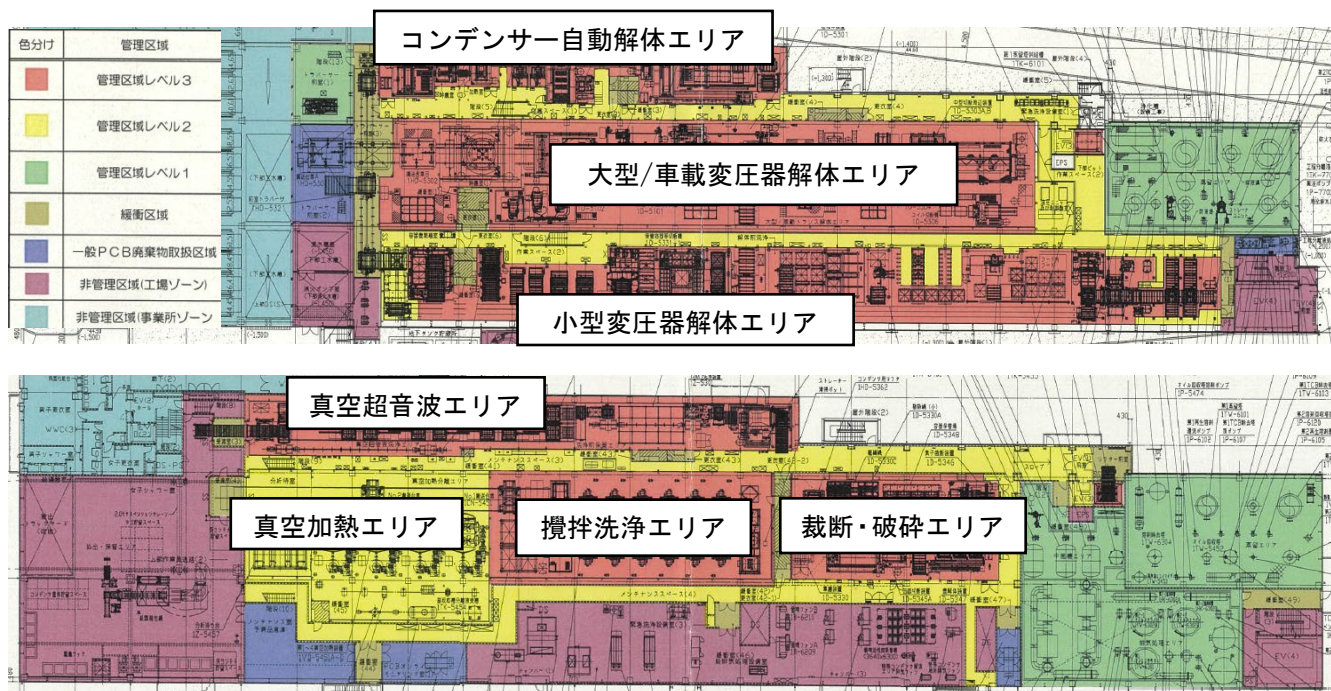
豊田事業所の平面図（上図 1 階、下図 4 階）
